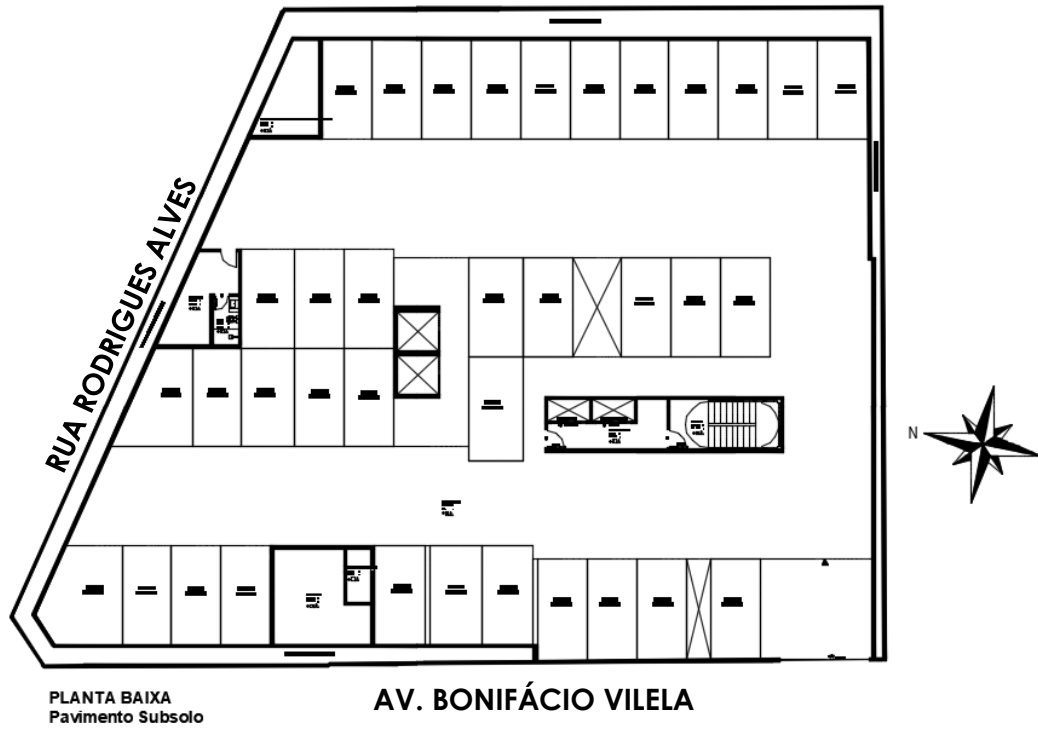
Projeto Arquitetônico - Pavimento SUBSOLO
